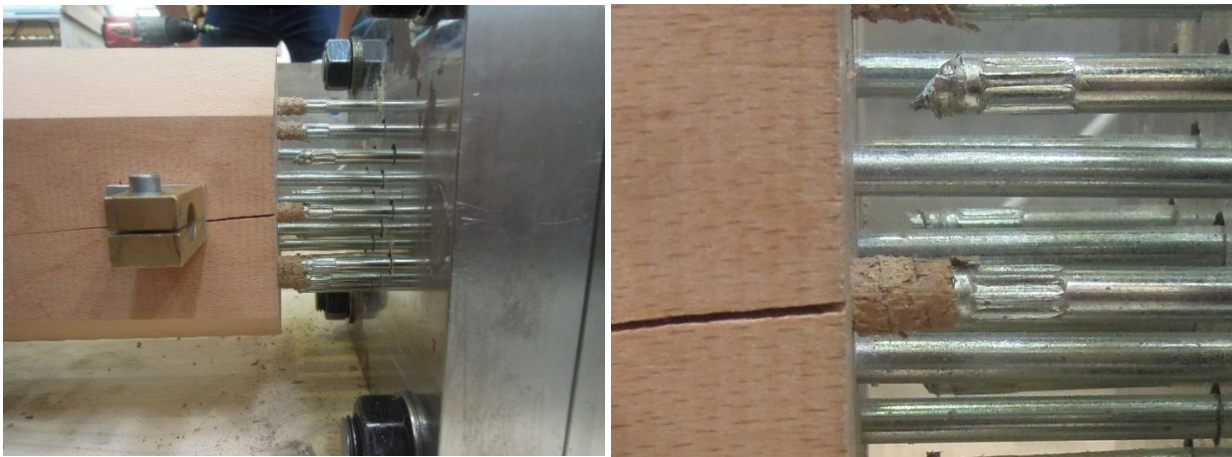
Kombiniertes Versagen Ausziehen der Schraube und Schraubenbrüche; links: Überblick versagte Verbindung; rechts: Detailansicht
